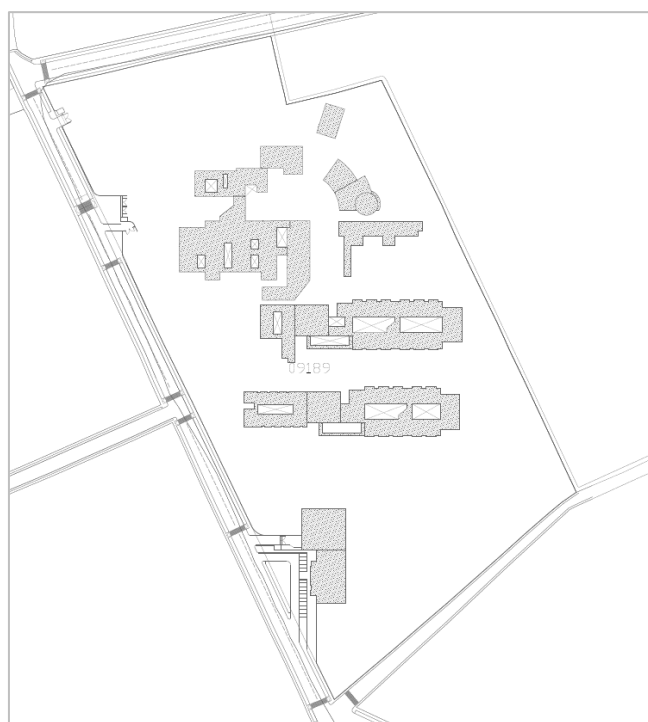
Plano de Ubicación y áreas techadas del proyecto.
